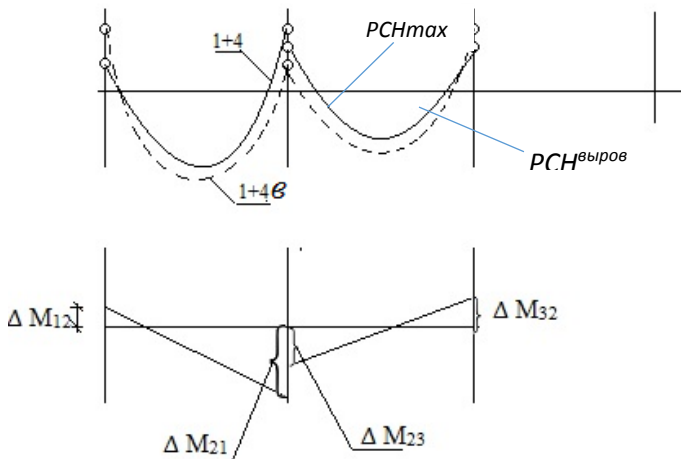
Схема перераспределения усилий в ригеле и схема выравняющей (треугольной) эпюры моментов
